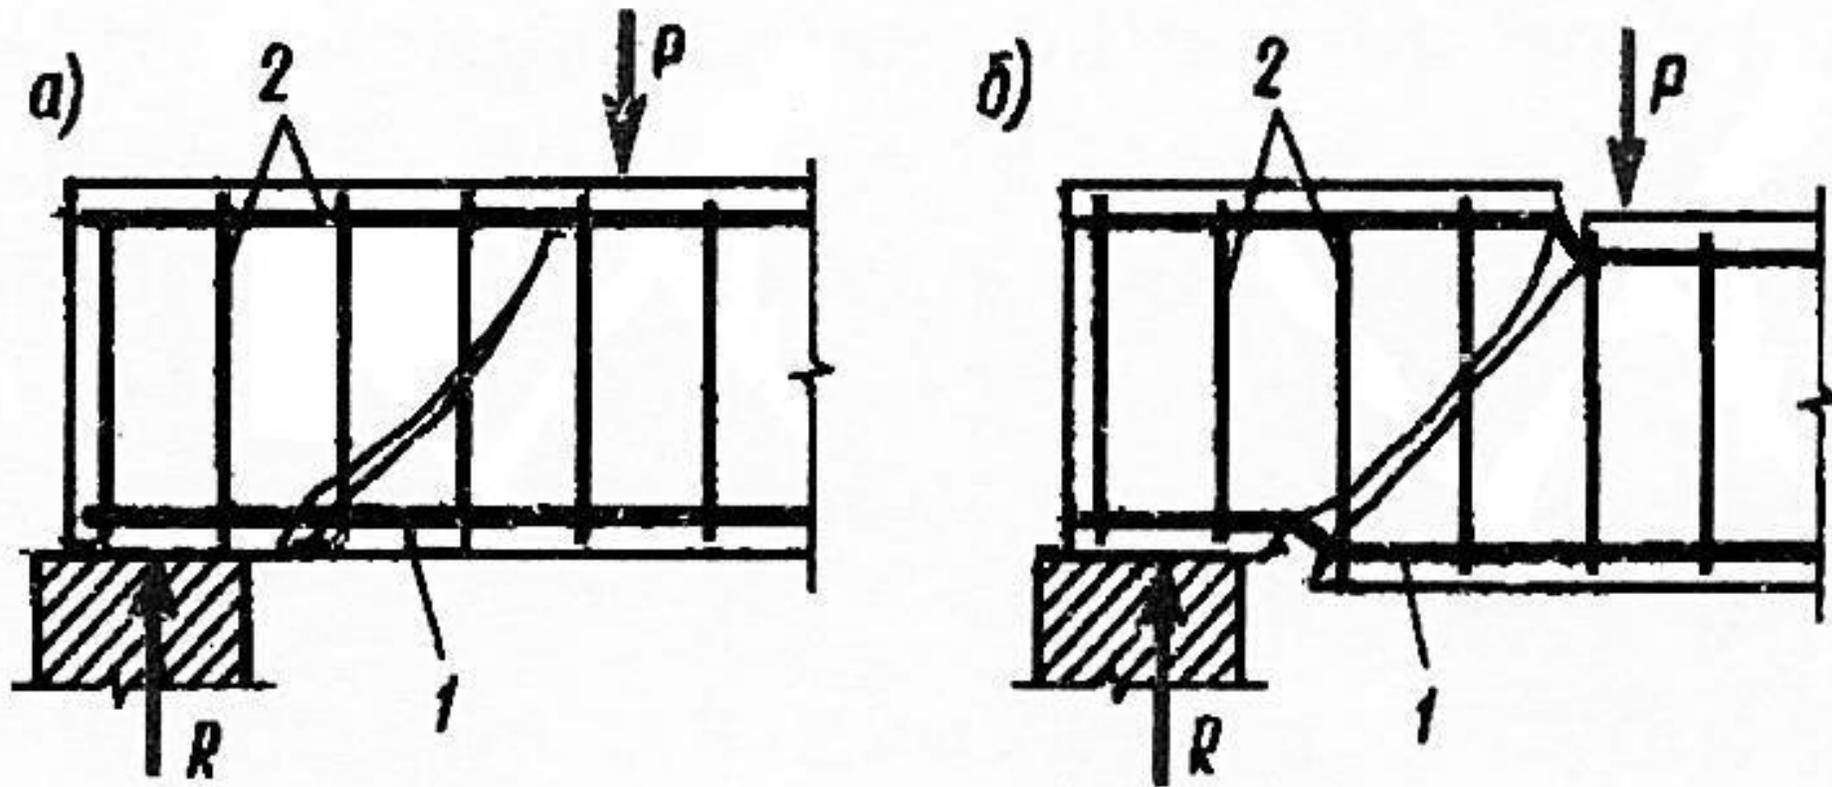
Типы разрушения балки по наклонным сечениям:
